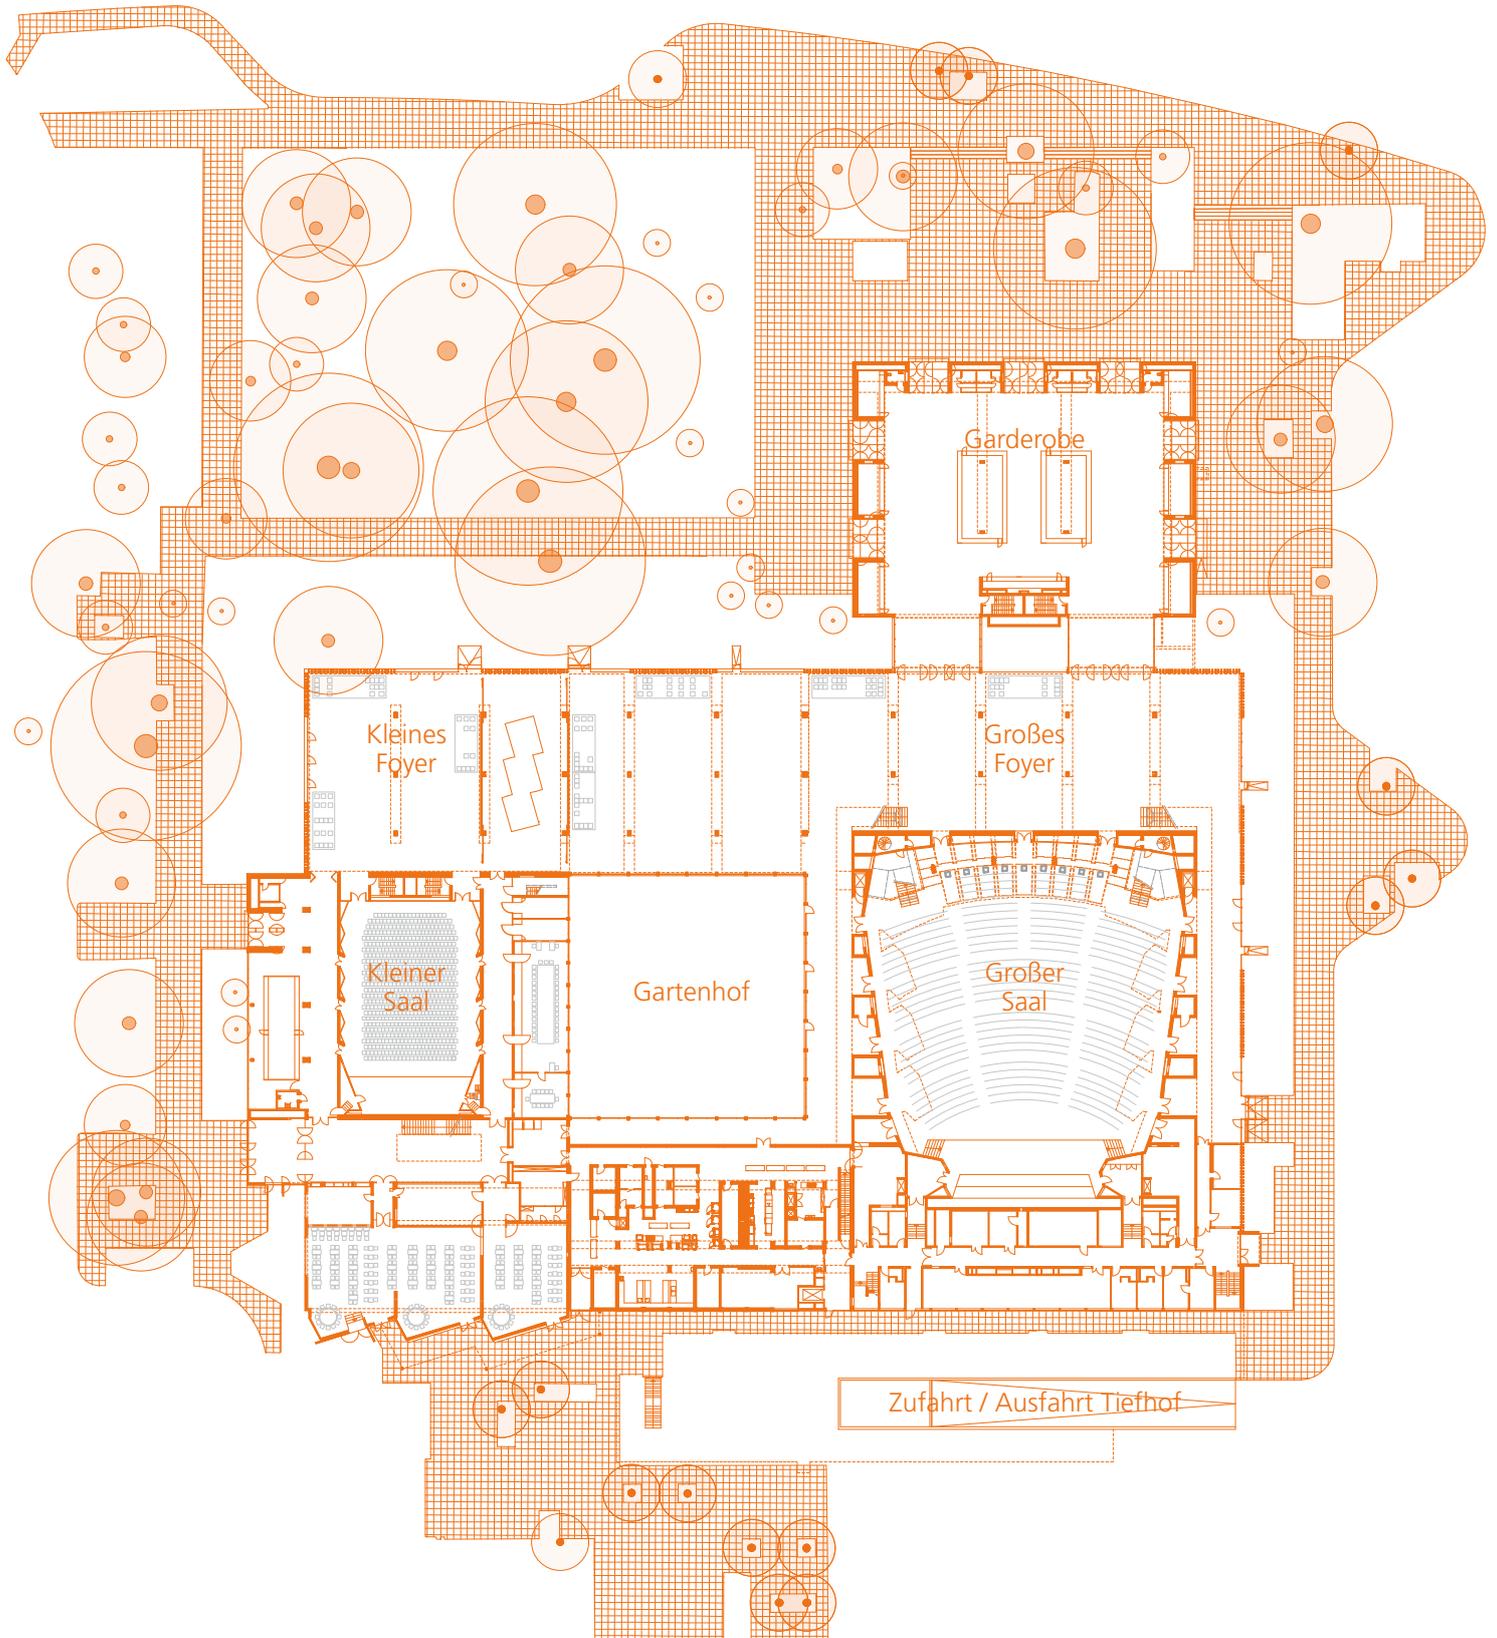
Grundriss Erdgeschoss der Meistersingerhalle (ohne Maßstab)
